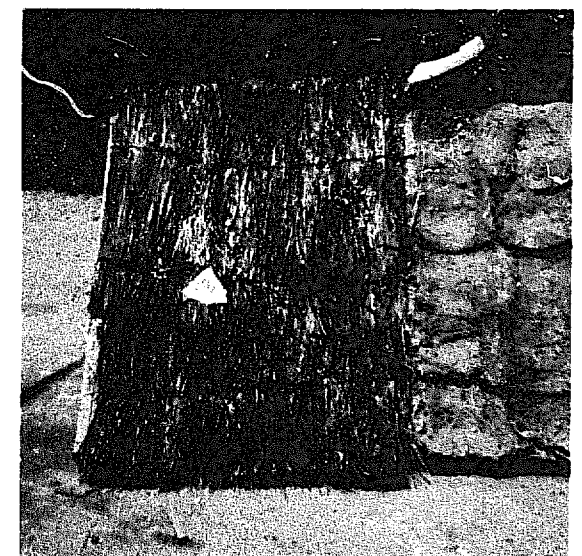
Fertige Dachprobe mit Wasserdichtungsanstrich.
